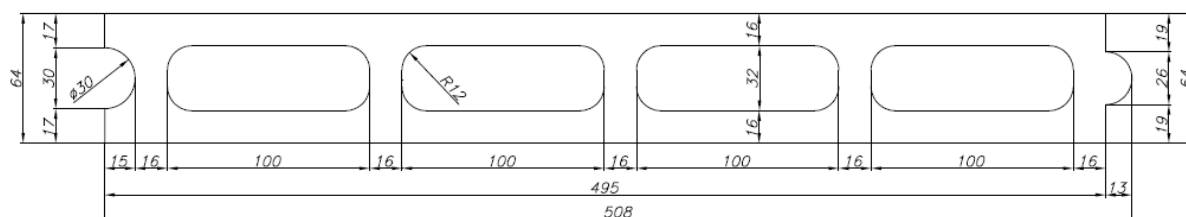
Detalles de la pieza GEROBLOK TABIQUE 38 dBA.
